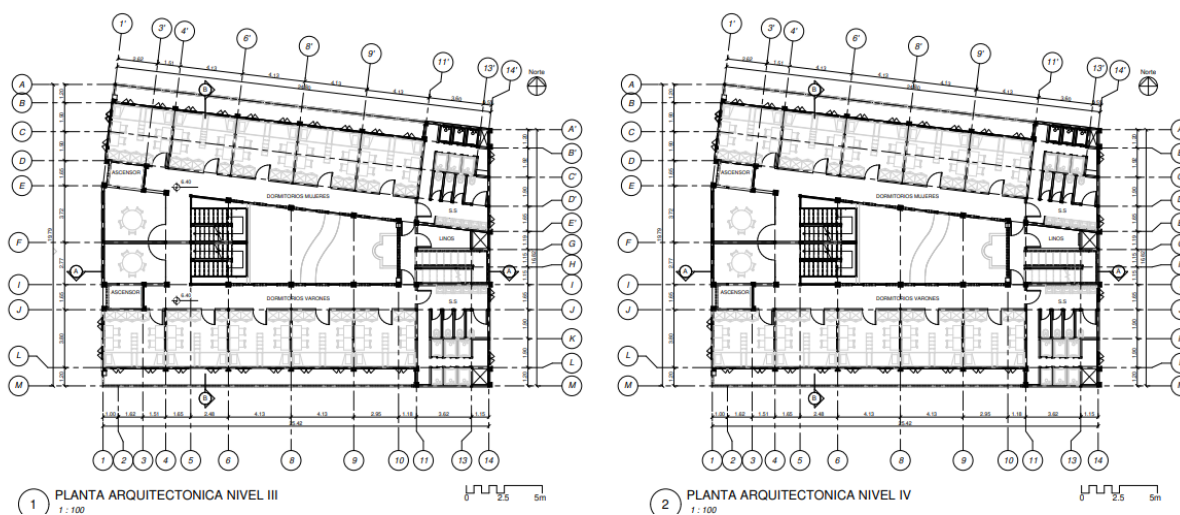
Propuesta Plantas Arquitectónicas Niveles III y IV. Fuente: Elaboración propia
